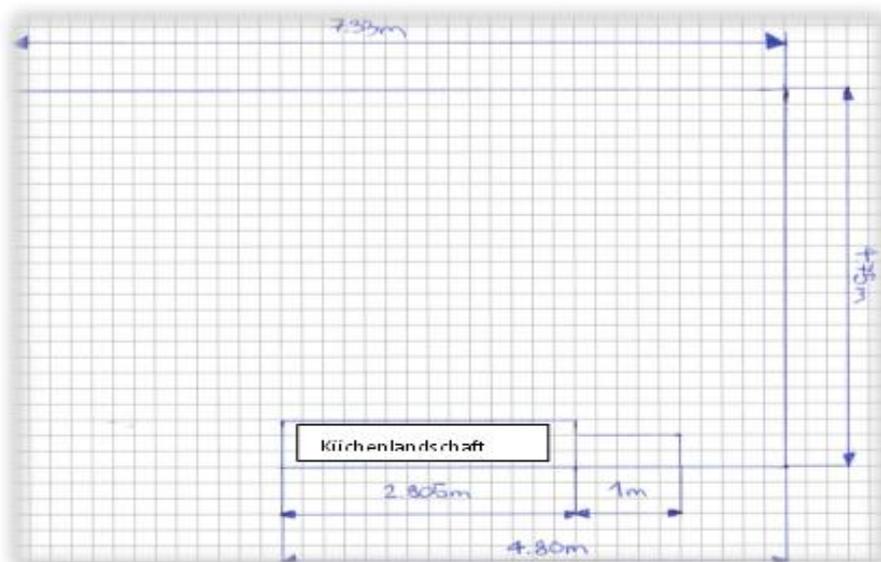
Grundriss Küche Handgezeichnet
